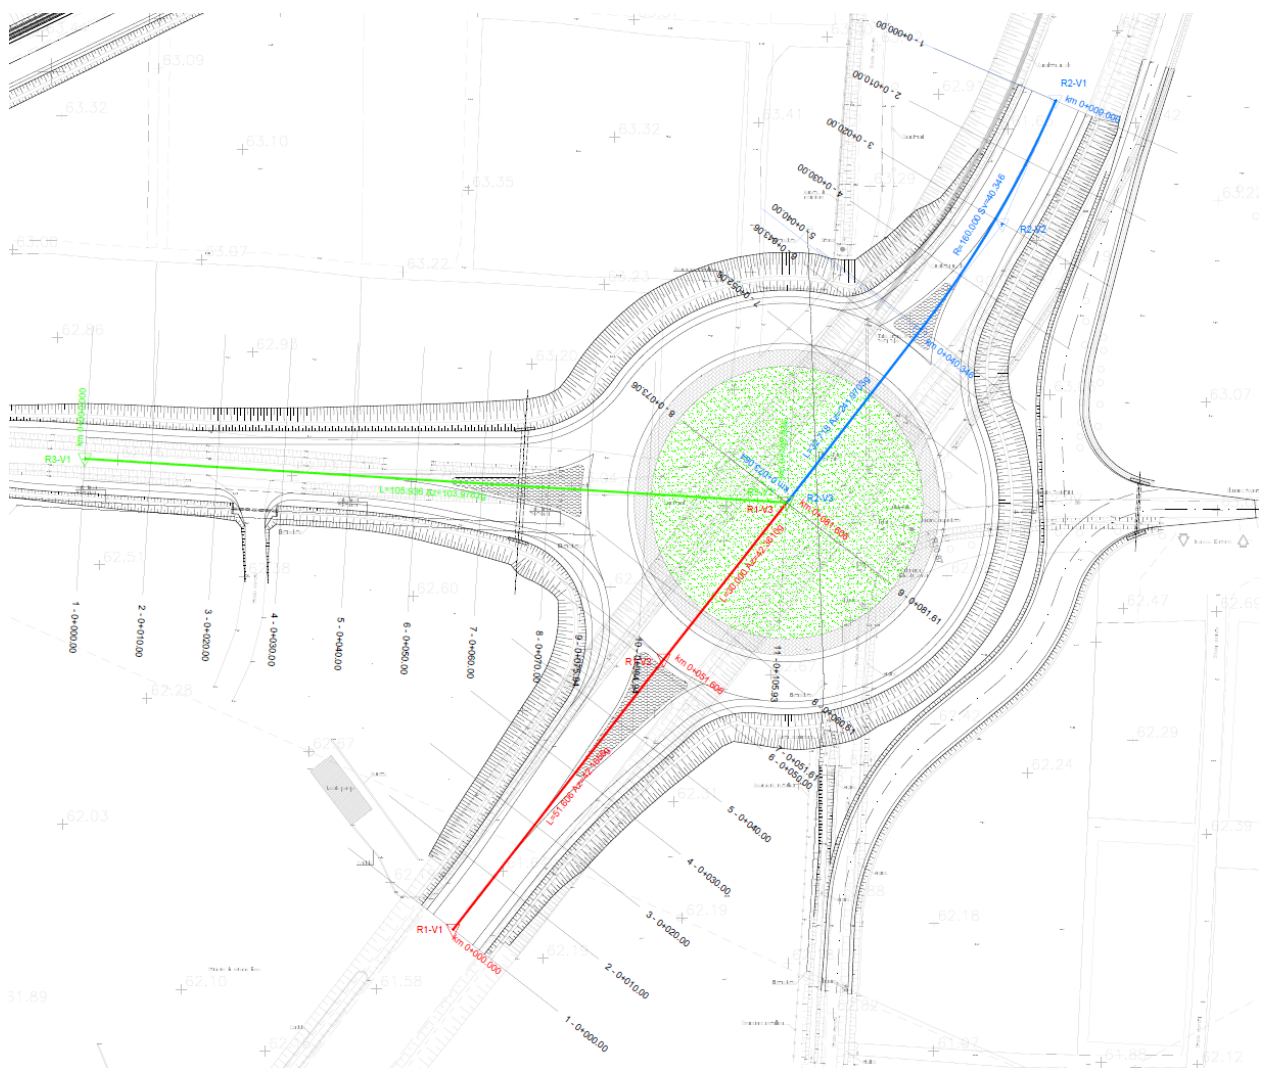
Planimetria di tracciamento dei bracci R1, R2 e R3.
